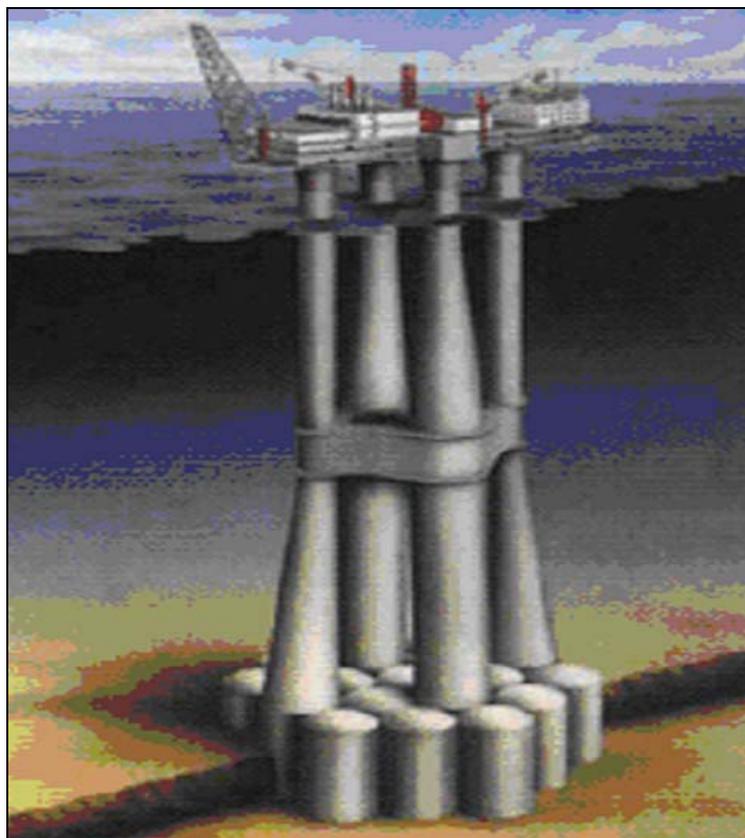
Plataforma fija de concreto o *Concrete Gravity Based Structure (GBS)*. [8]
